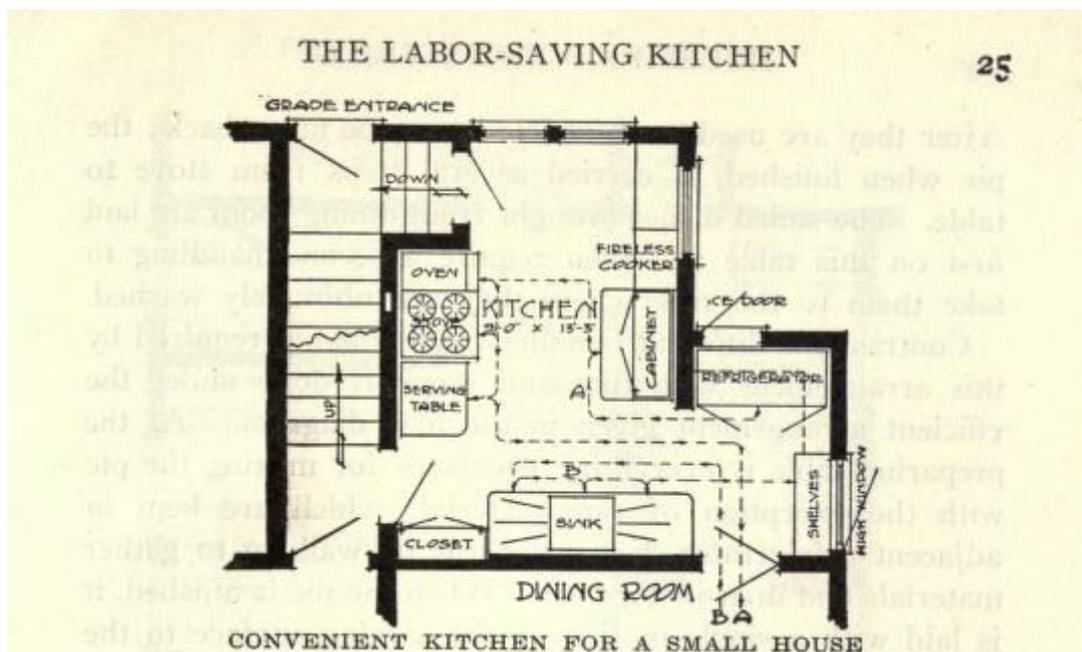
Grundriss arbeitssparende Küche für ein kleines Haus, Christine Frederick
